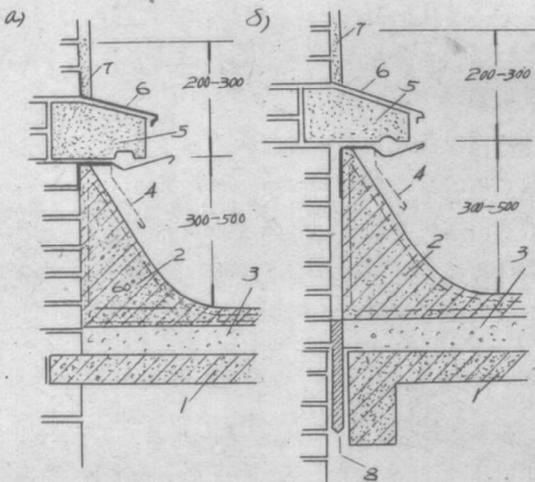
鋼筋混凝土剛層(防水層下的基層)的连接:
